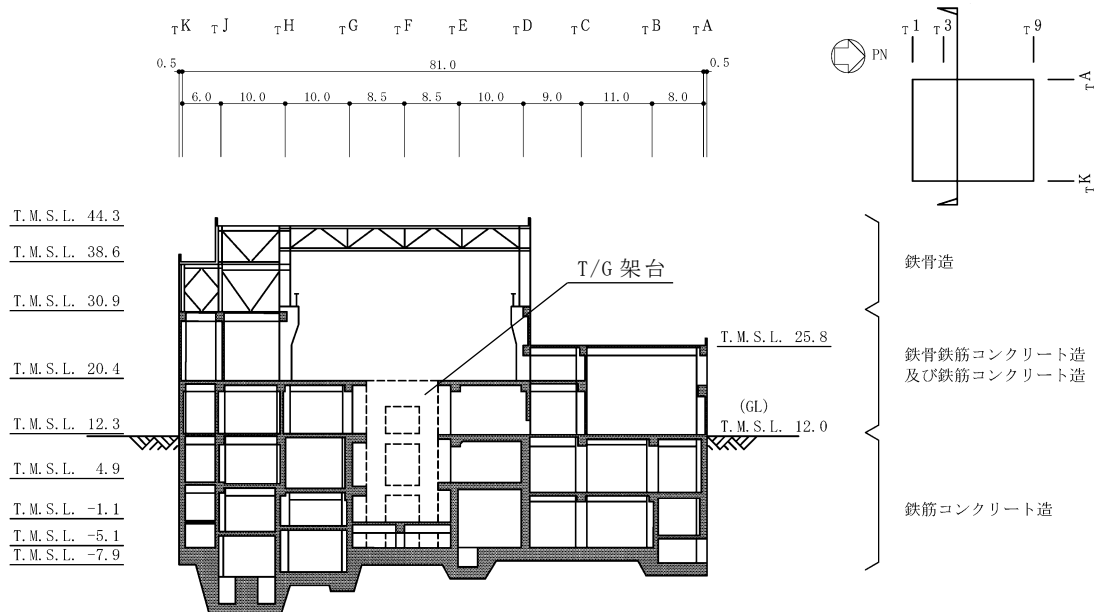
タービン建屋の概略断面図 (EW 方向) (2/2) (単位 : m)
